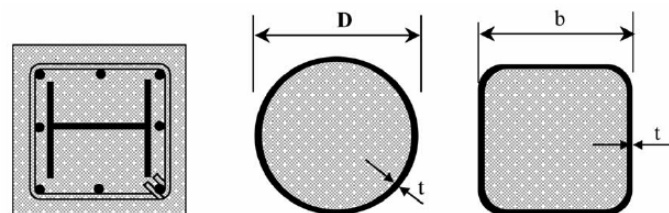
Secciones compuestas generalmente utilizadas en elementos tipo columna (Ayoub & Filippou, 2000).
